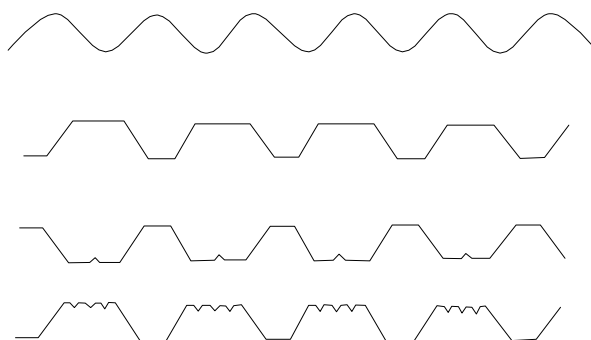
Seções transversais usuais de painéis, decks e chapas corrugadas.
